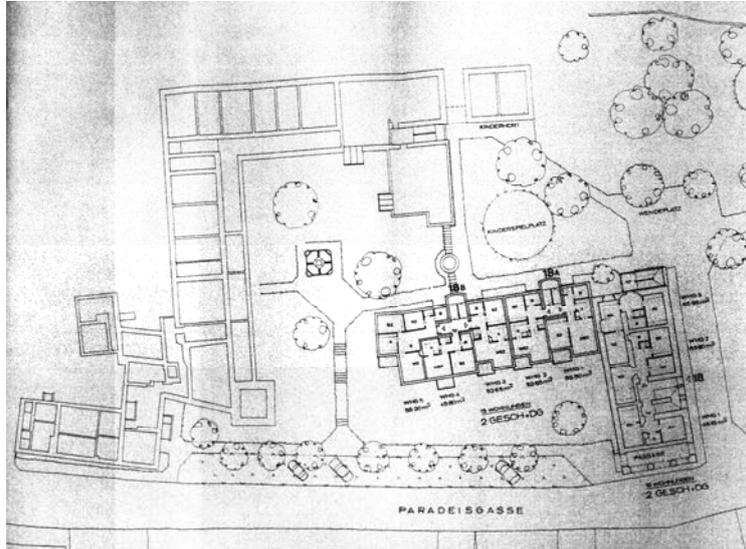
Architektenbüro Dipl.-Ing. Otto Landl und Dipl.-Ing. Hans Baier, Revitalisierung Paradeisgasse, Plan 2, 1985, Kopie, Ausschnitt
